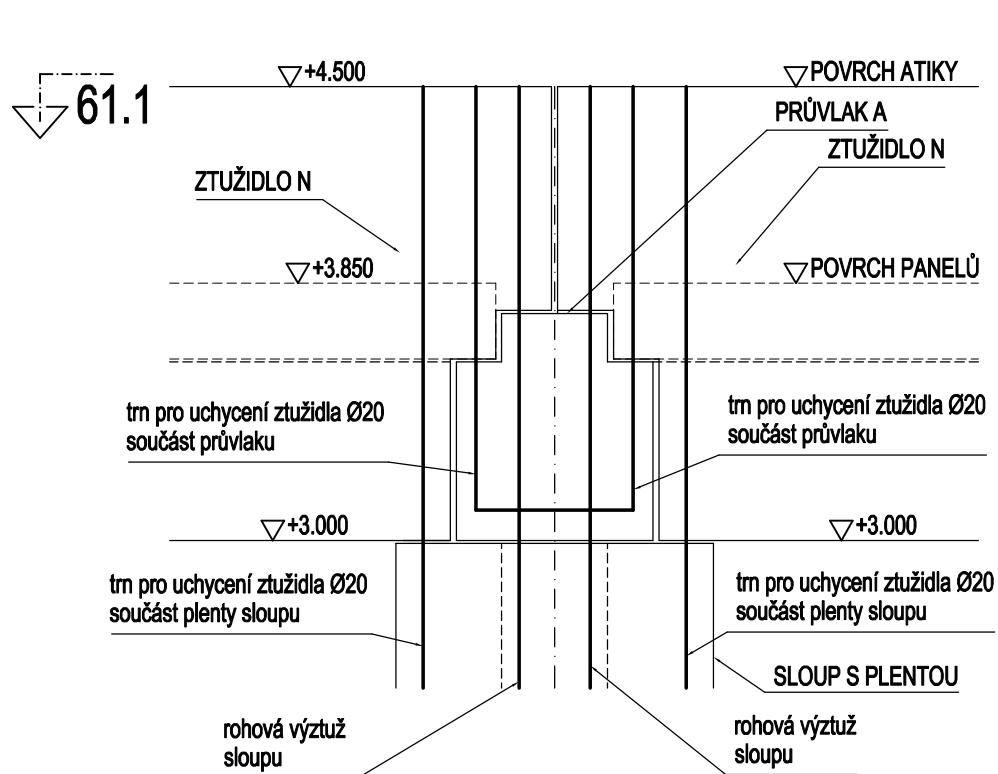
SPOJENÍ PRŮVLAKU SE SLOUPEM A STĚNOVÝM ZTUŽIDLEM (PŘEKLADEM)
